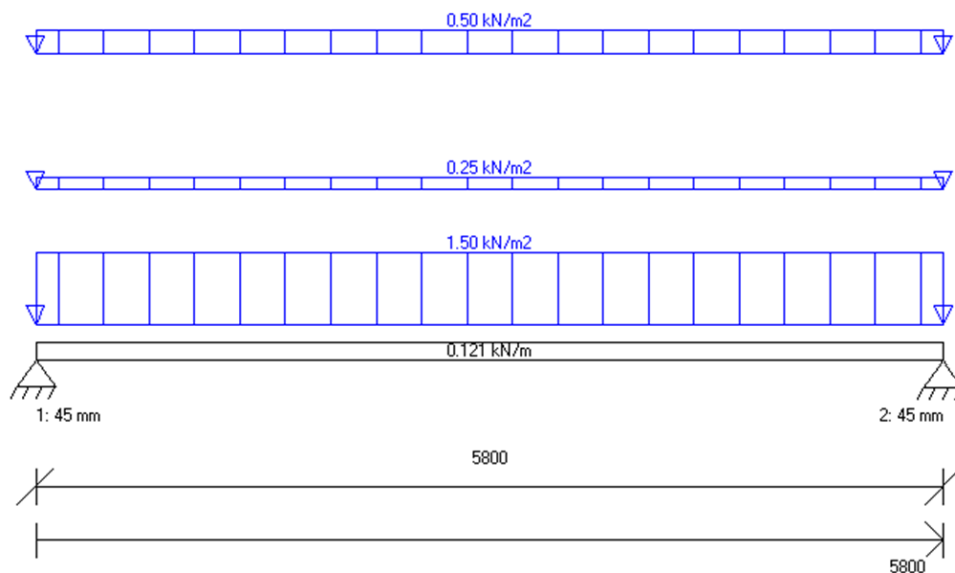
Sistema de Vigas em Pinho Nórdico – Montagem
